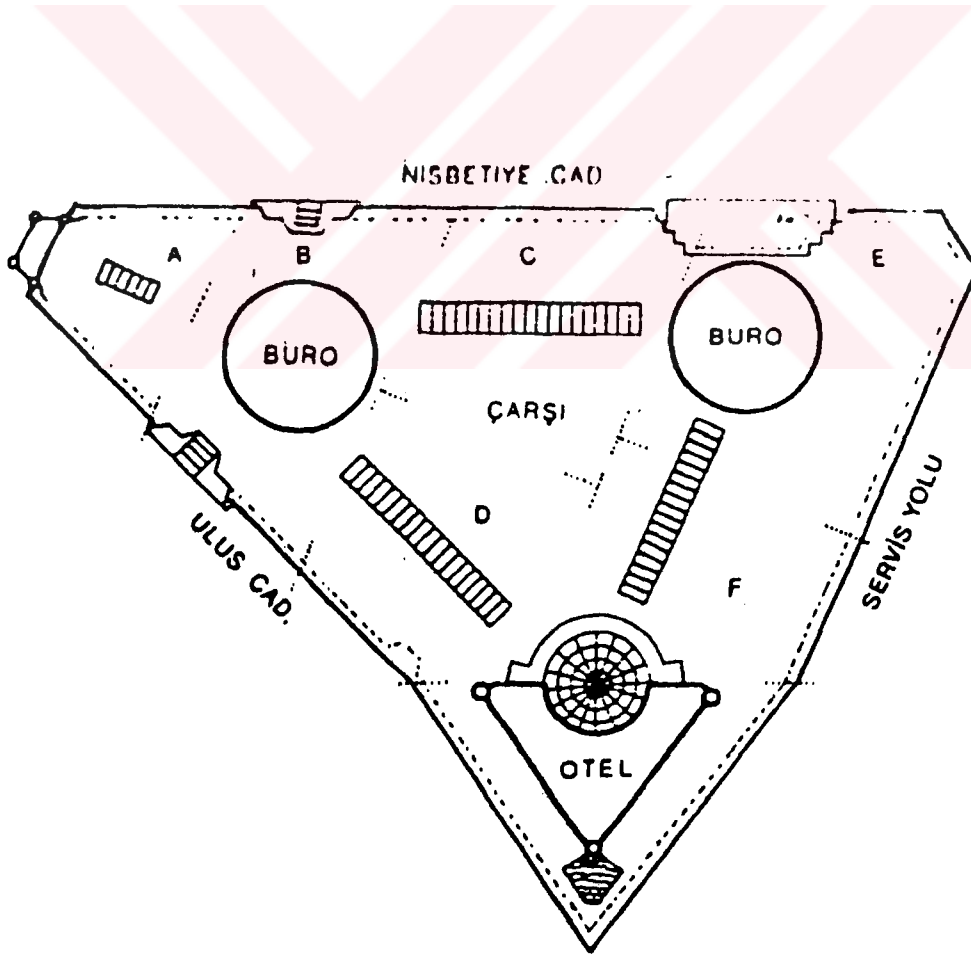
Nova Baran Plaza . Büro katları planı ve kesit.
